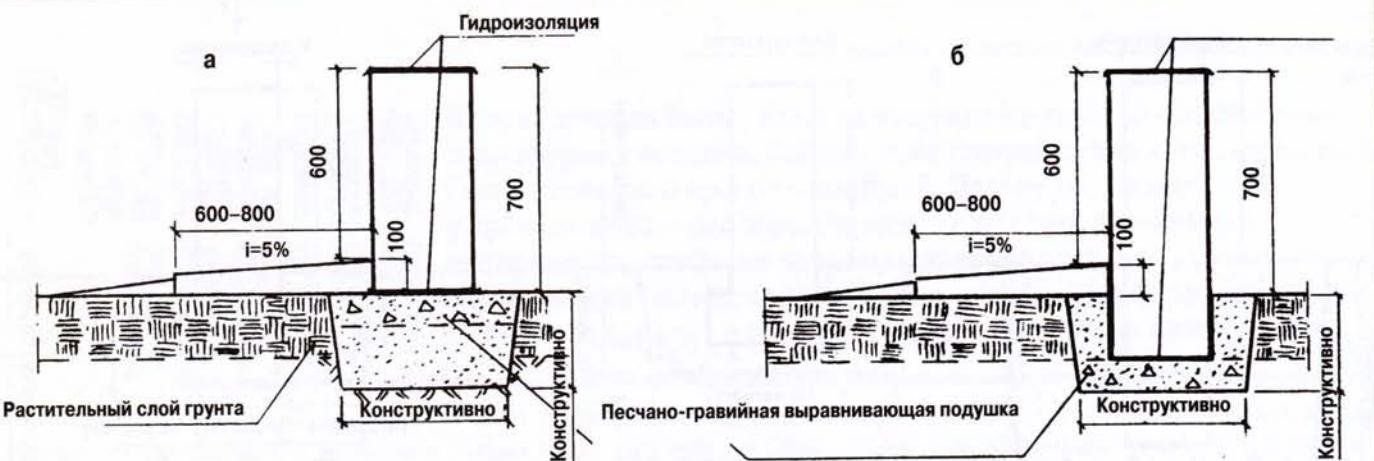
Конструкция основания и фундаментов в непучинистых грунтах:
